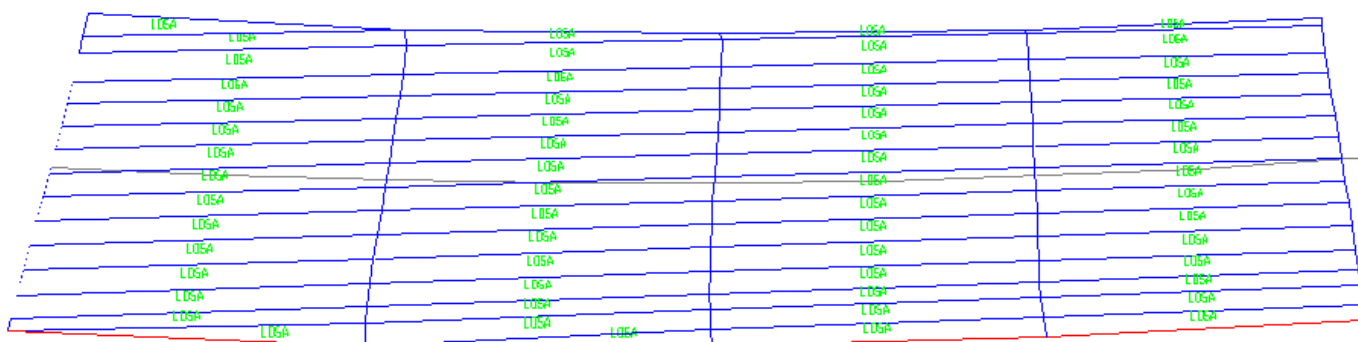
ARREGLO DEL LOS ELEMENTOS DE ÁREA (AREA SECTIONS) EN EL TABLERO.
